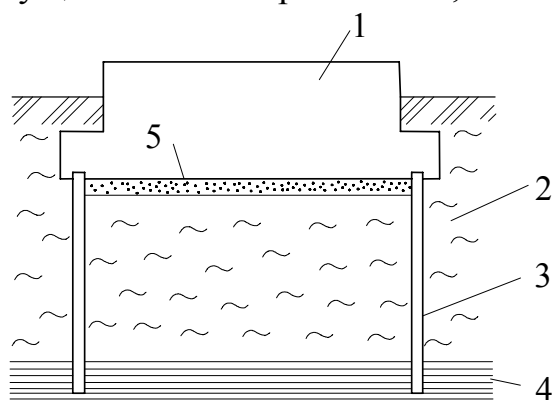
Усиление грунтового основания путем устройства шпунтового ограждения; 1 - фундамент; 2 – слабый грунт; 3 – шпунтовое ограждение; 4 – плотный грунт; 5 – песчаная подготовка
